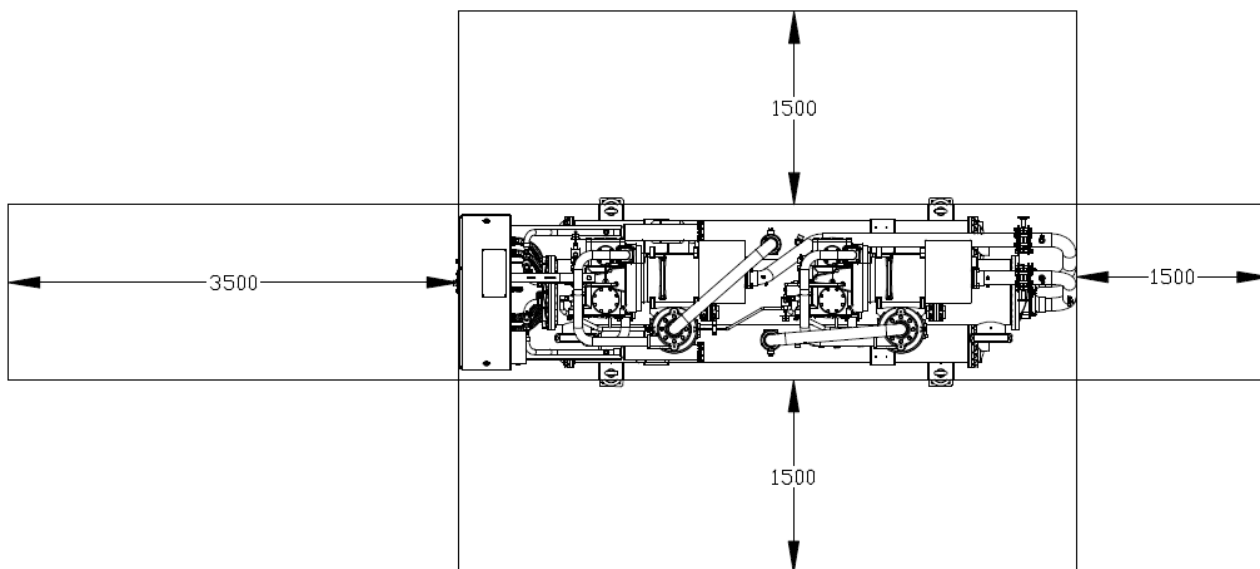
Cerințe minime clearance-ul pentru întreținerea mașinii
